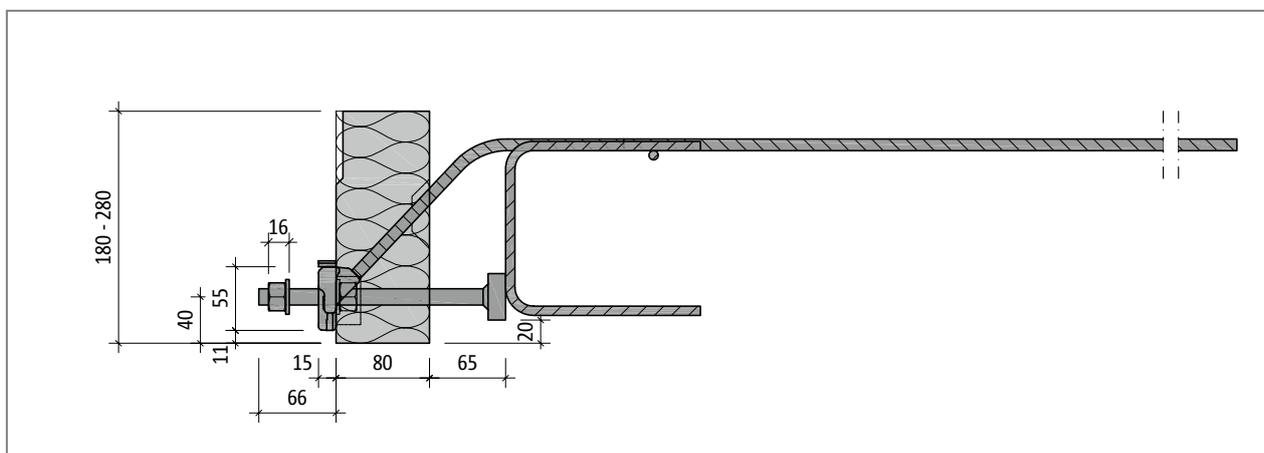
Schöck Isokorb® T type SQ-V2 : coupe du produit
